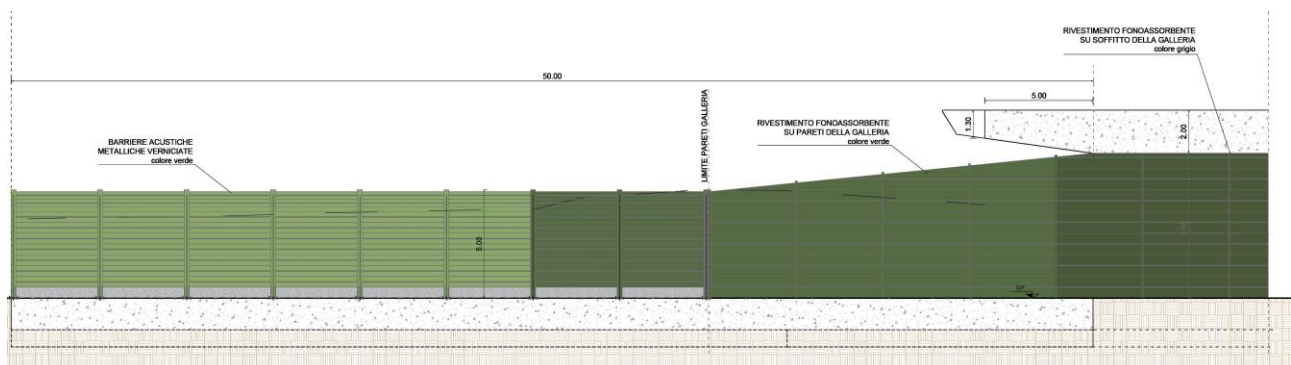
Planimetria e sezione tipo della barriera acustica in prossimità del ricettore 1005
